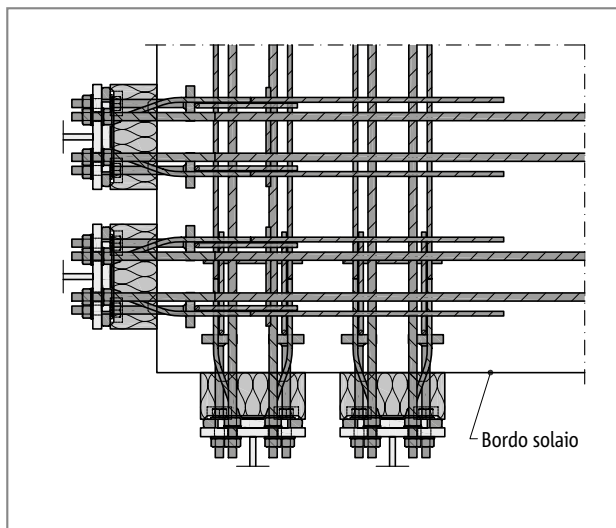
Schöck Isokorb® T tipo SKP: angolo esterno
